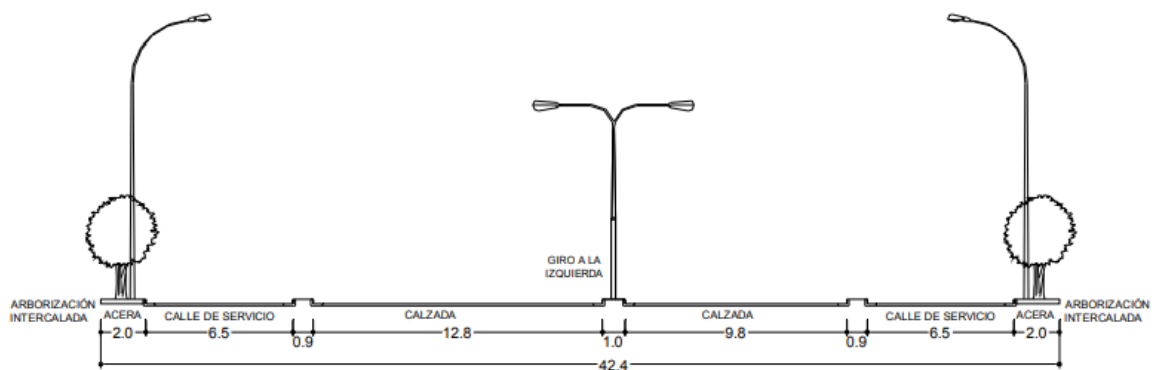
Perfil vial Av. Perimetral Oeste (2020)
